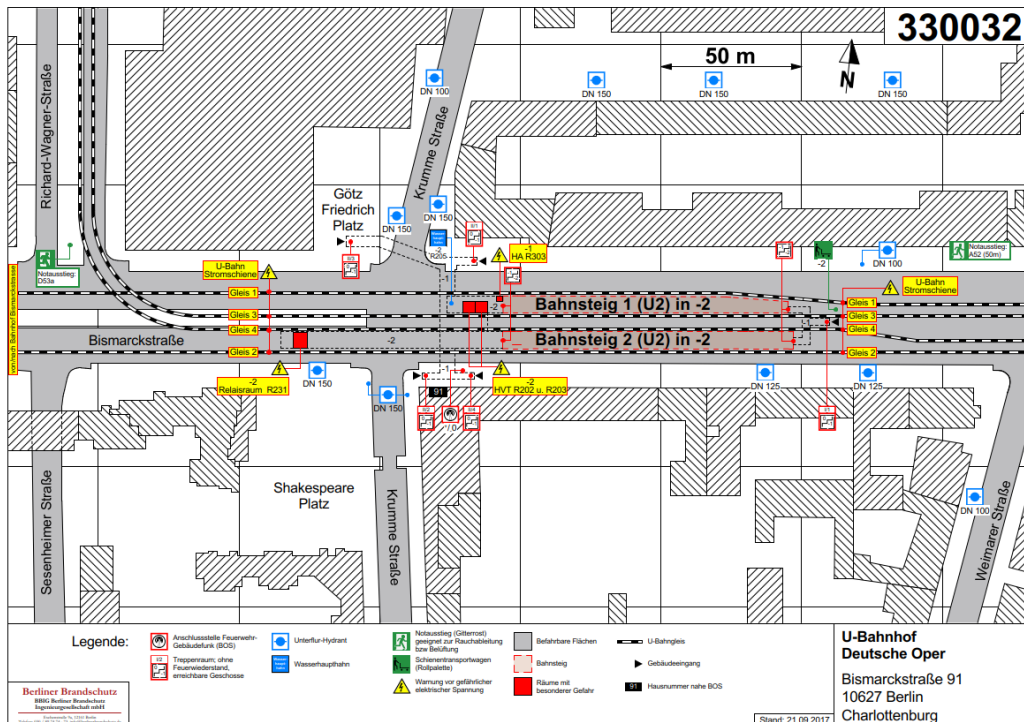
Lageplan zur Übersicht (Quelle: openstreetmaporg.de)
